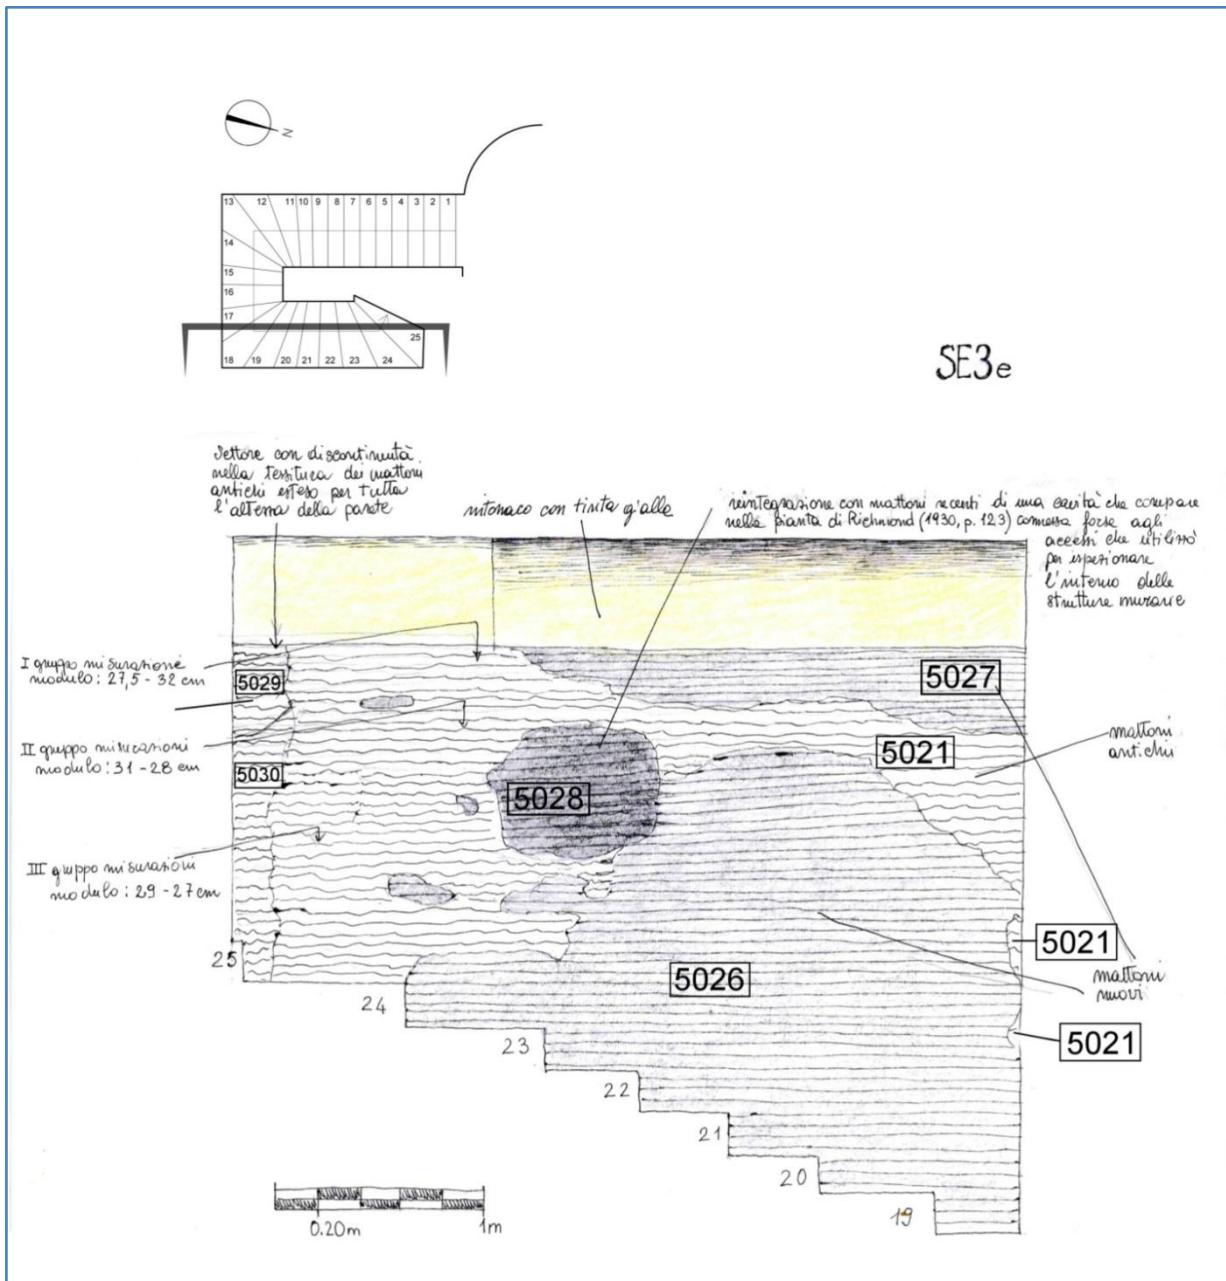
Prospetto SE3e. Disegno D'Ippolito.
